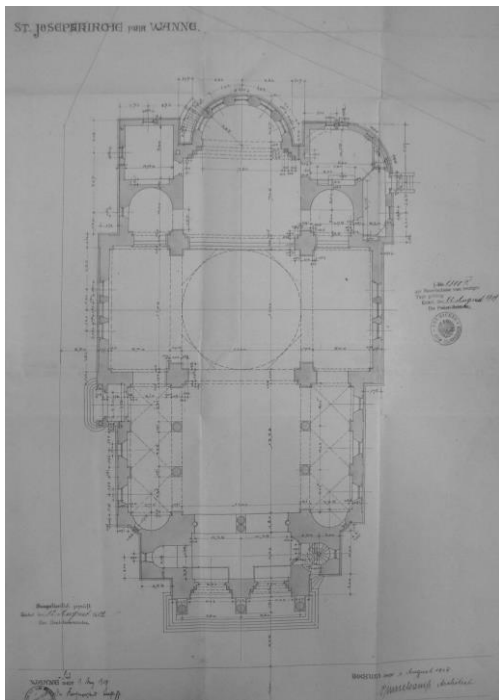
Grundriss, 01.08.1908
